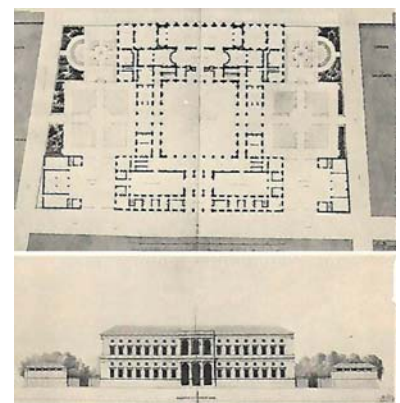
Planta y alzado Palacio d'Orsay, 1810
